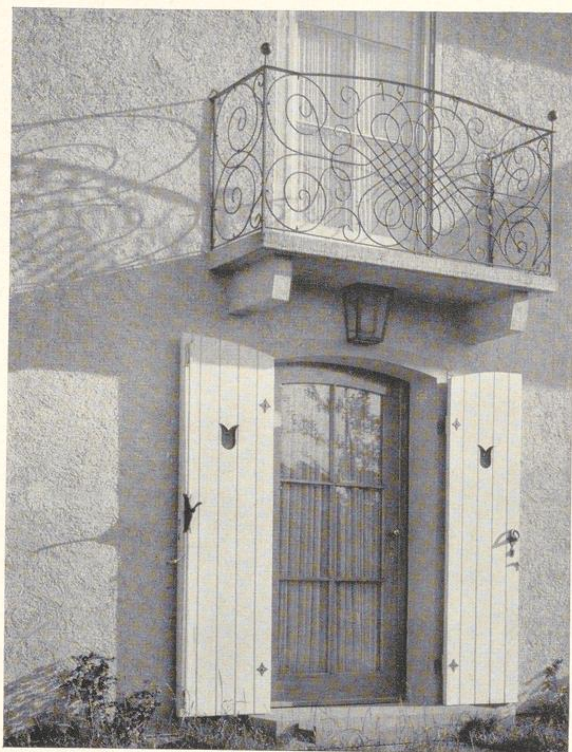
Scheibputz, rund verrieben. Guter Zusammenklang mit Türe und Balkon. Arch. Ernst Breitling, Tübingen
